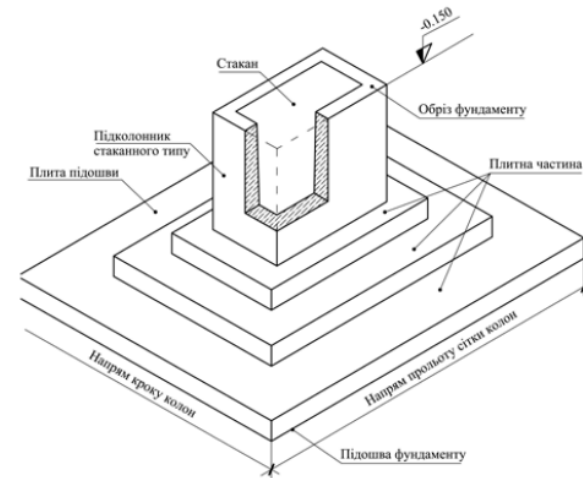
Загальний вигляд монолітного фундаменту під залізобетонну колону основного каркаса
